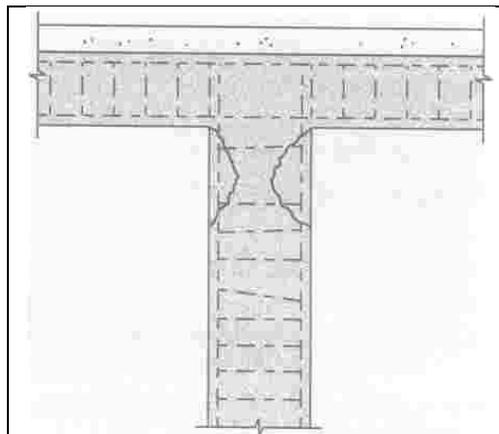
Fisuras de compresión localizada¹⁸
